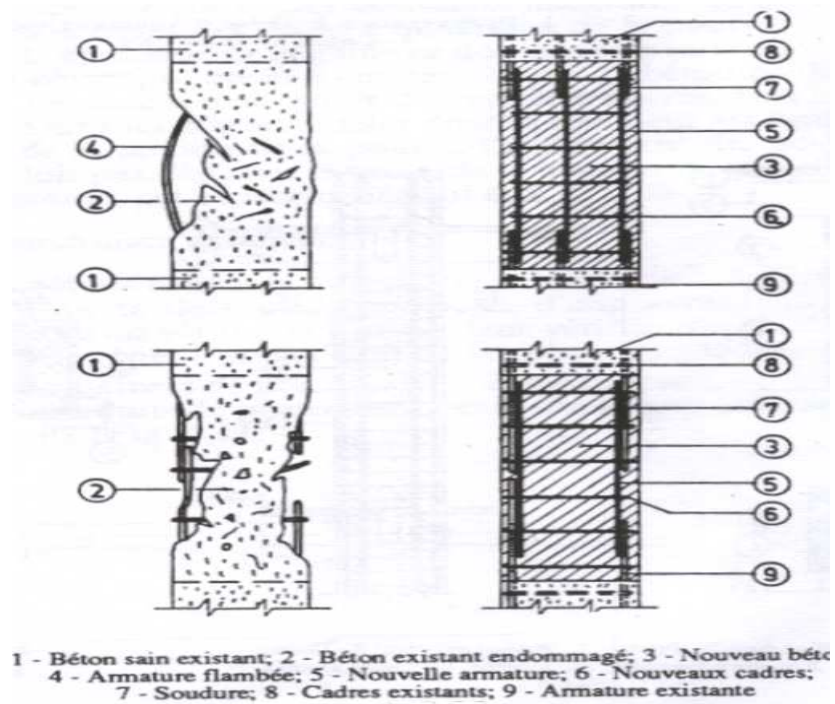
Gainage d'un poteau en béton armé [22]
